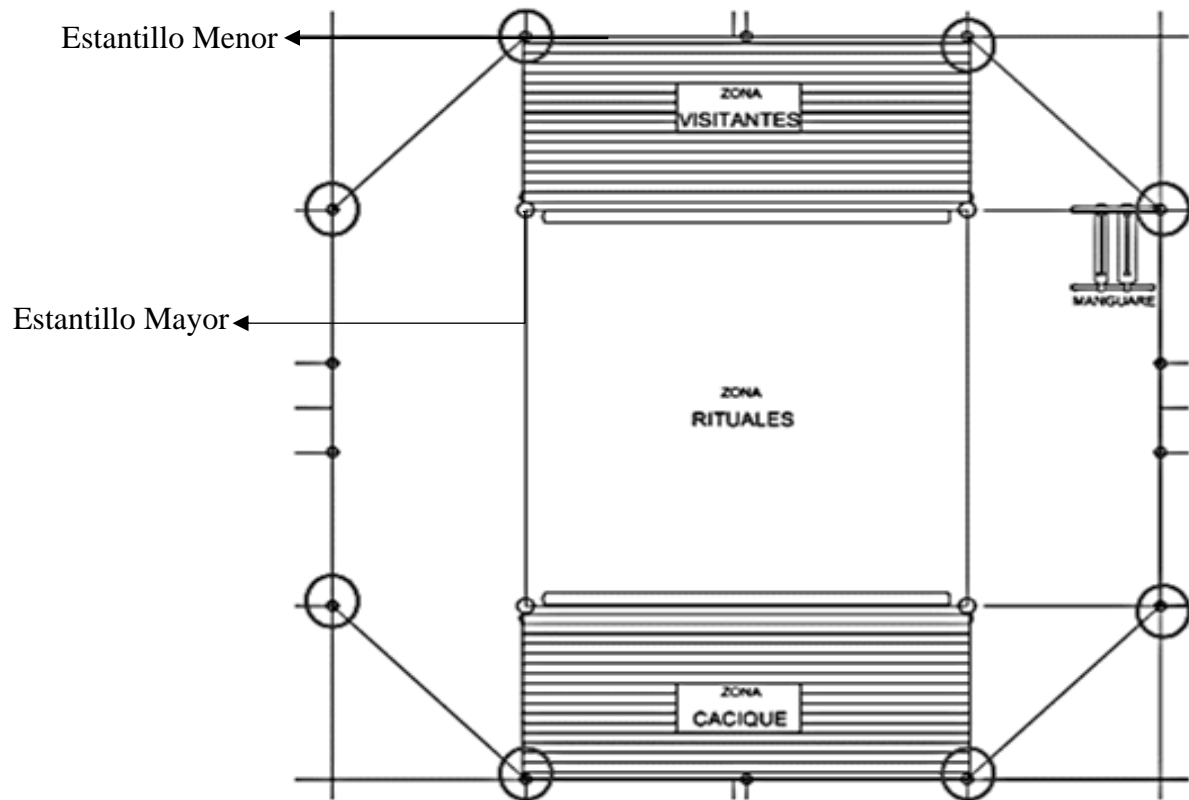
Planta Arquitectónica. Ubicación de estantillos. Elaboración propia con AutoCAD
